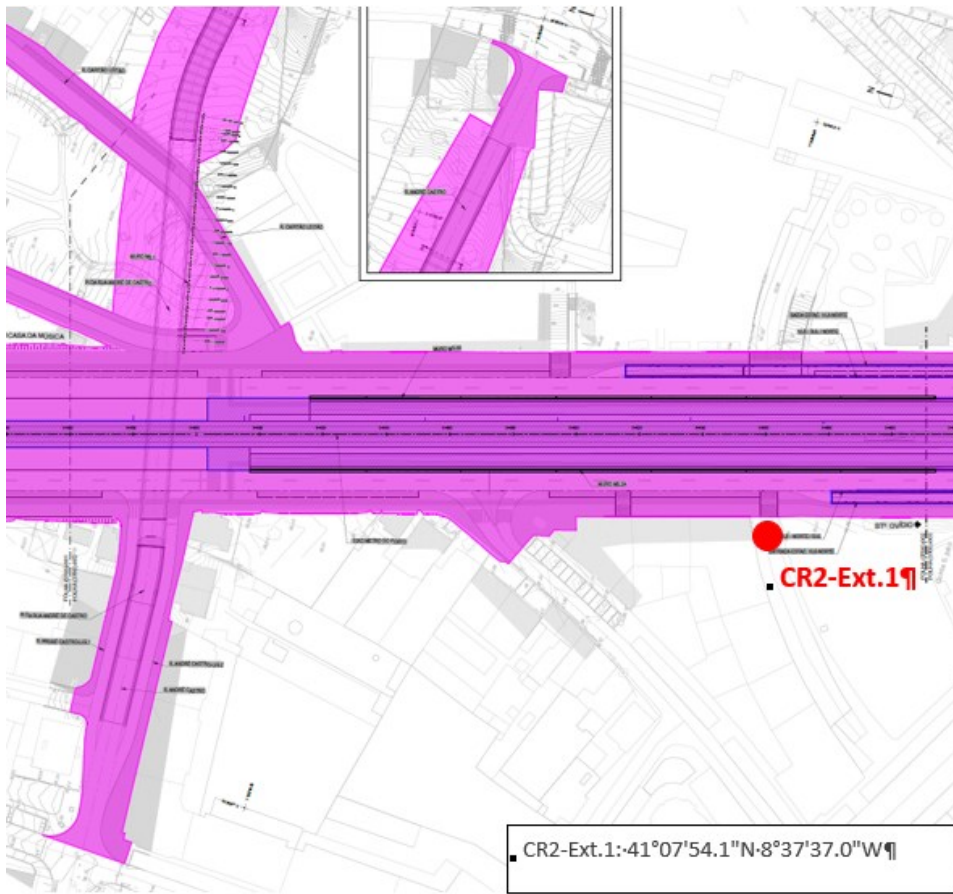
Pontos de monitorização Candal-Rotunda-2 (vibrações – construção)
